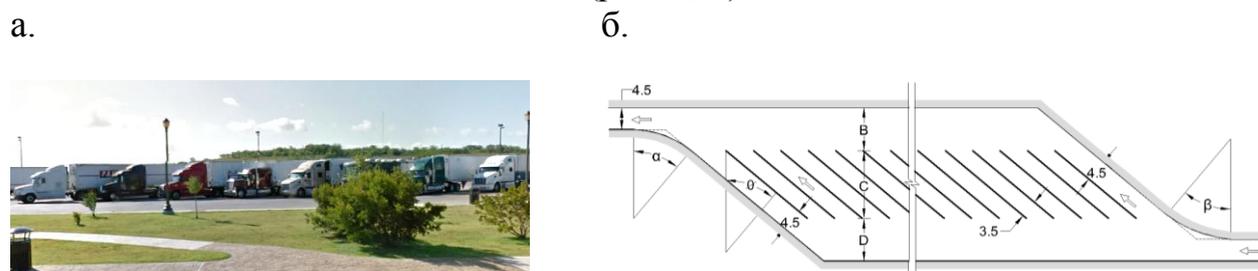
Общий вид (а) и разбивка парковочных мест для крупногабаритных грузовых автомобилей с расположением парковочных мест под углом
